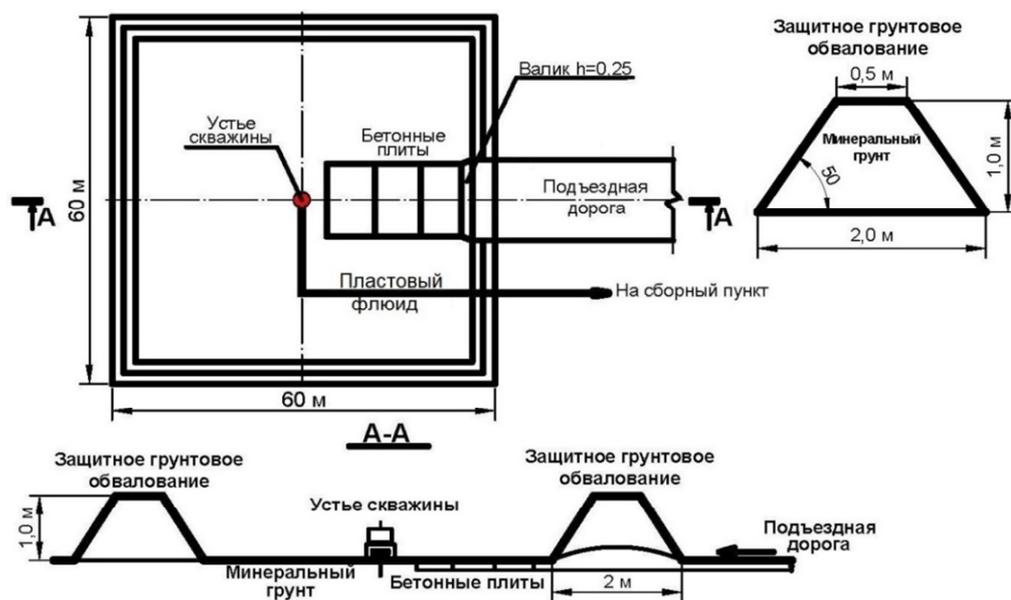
Схема промышленной площадки скважины при устройстве защитного грунтового обвалования
